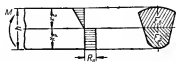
28. Эпюра напряжений в бетонном изгибаемом элементе.
